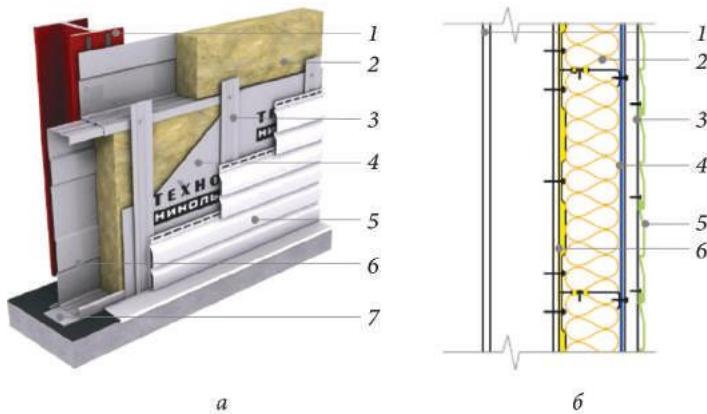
Фасадная система из сборных сэндвич-панелей *TH-ФАСАД Сэндвич*: а — общий вид; б — схема; 1 — несущая рама здания; 2 — минераловатный утеплитель *ТЕХНОЛАЙТ*; 3 — контррейка (металлический профиль); 4 — гидро-, ветрозащитная пленка; 5 — виниловый сайдинг; 6 — сэндвич-профиль; 7 — пароизоляционная уплотнительная лента
